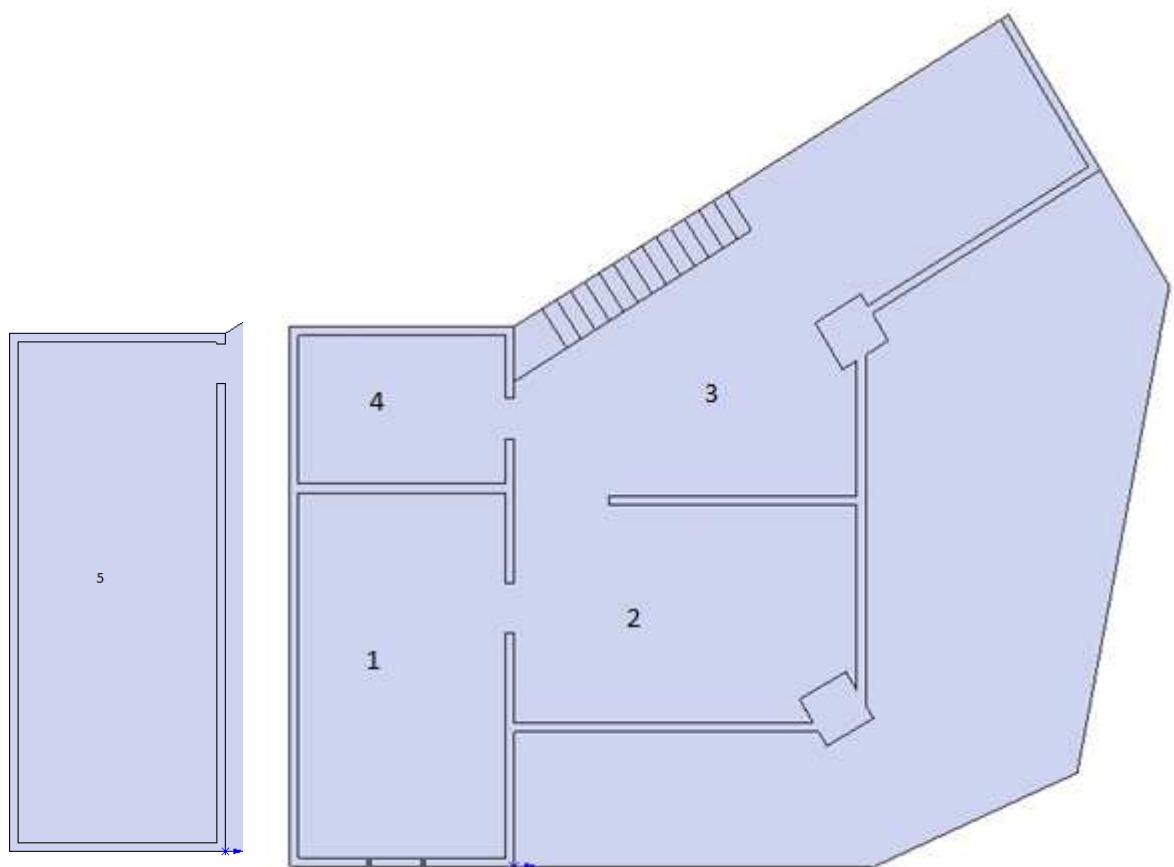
Plano general de la nueva distribución planta 1 y 2
